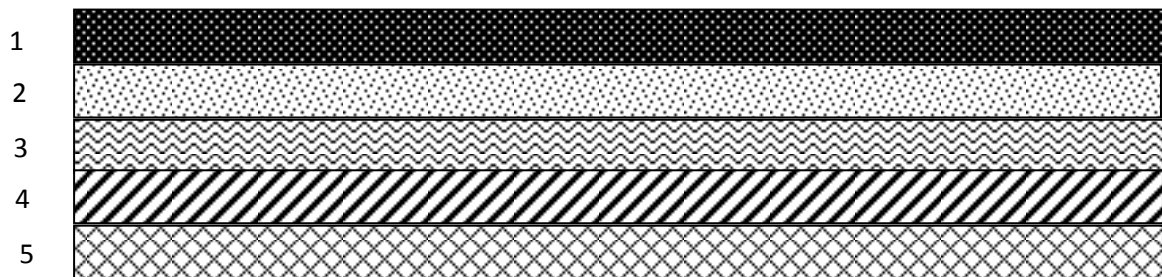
Coupe verticale du plancher d'étage courant
